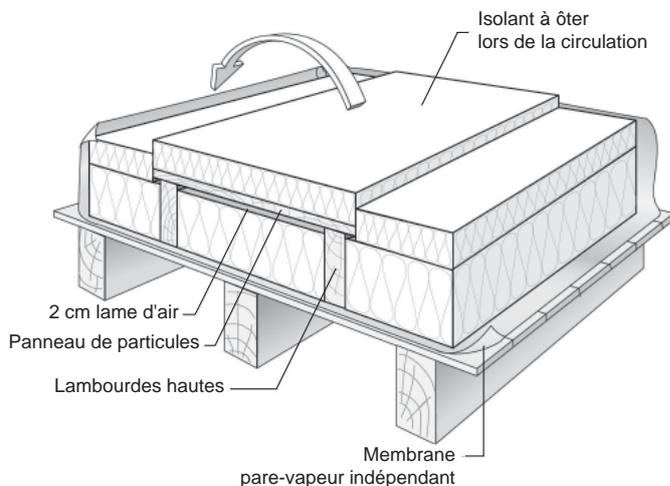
Isolation en combles sur plancher bois : panneaux posés bord à bord
